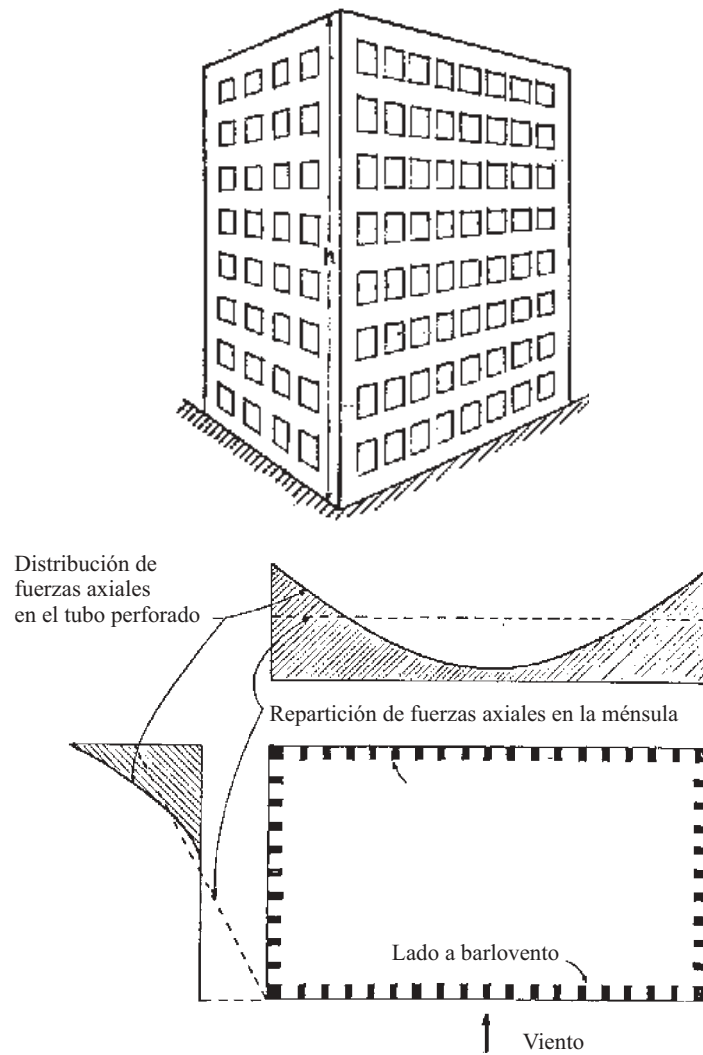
Tubo estructural. (a) Estructura del edificio; (b) Distribución de fuerzas normales en columnas
